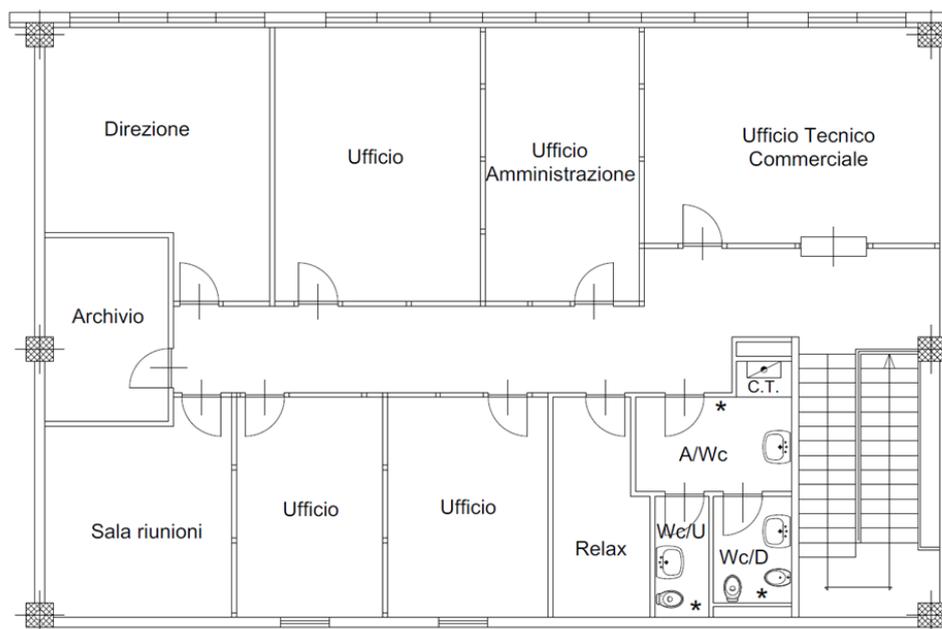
Planimetria primo piano dello stabilimento Sargomma
